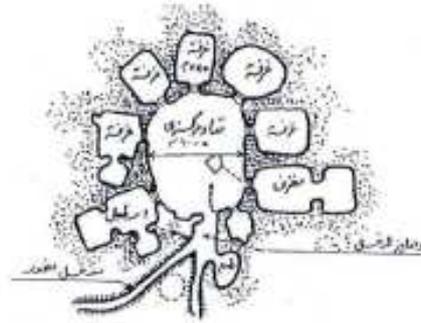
مسقط أفقي للدور الأرضي بدار ببلدة تالي
